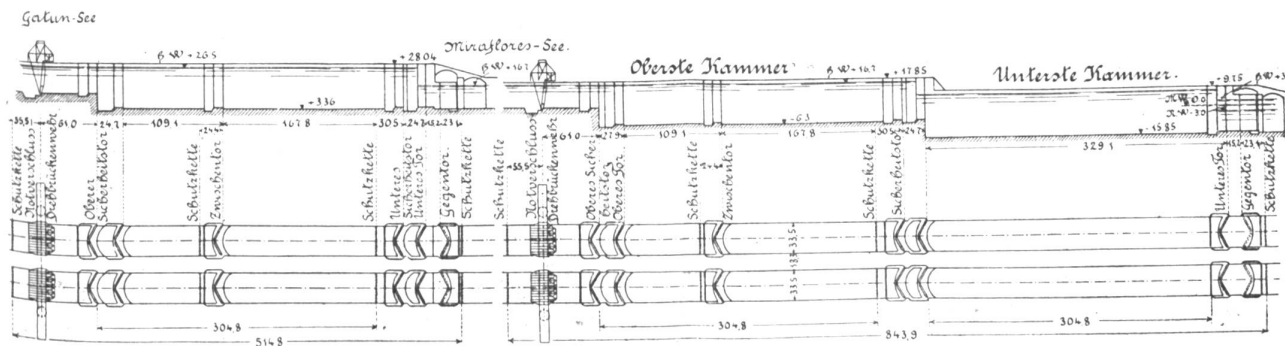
Grundrisse und Längsschnitte der Doppelschleuse bei „Pedro Miguel“ und der zweistufigen Doppelschleusentreppe bei „Miraflores“.
